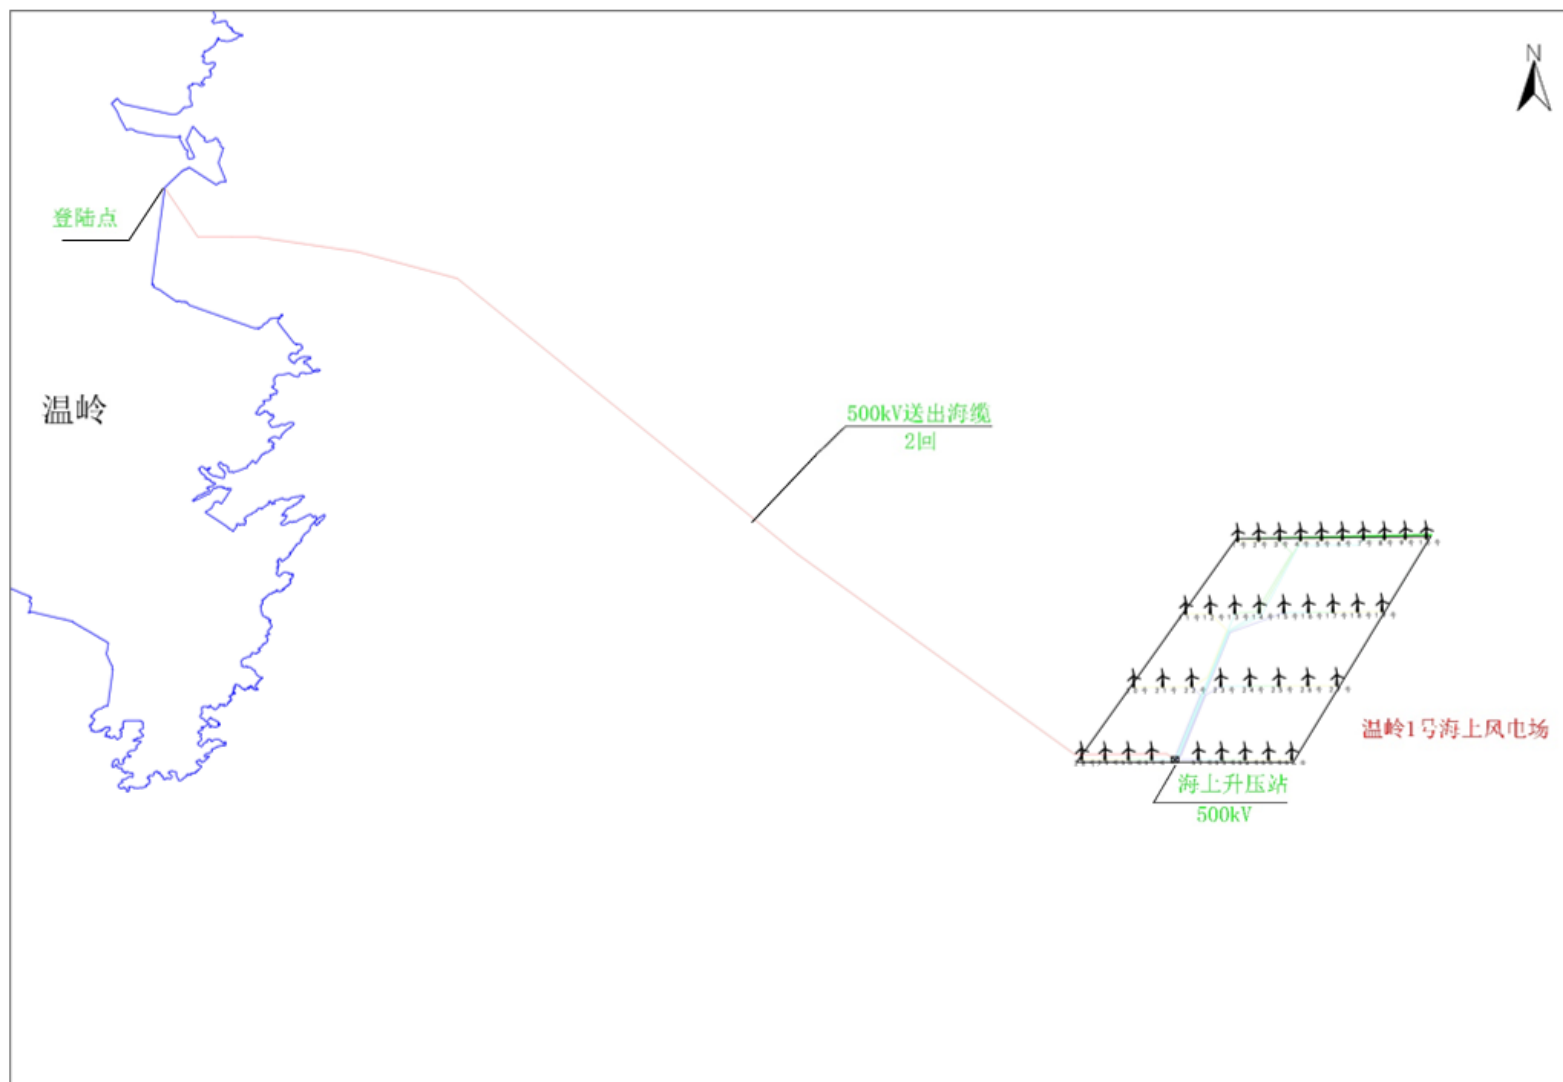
出让海域拟建风电场项目总平面布置图
